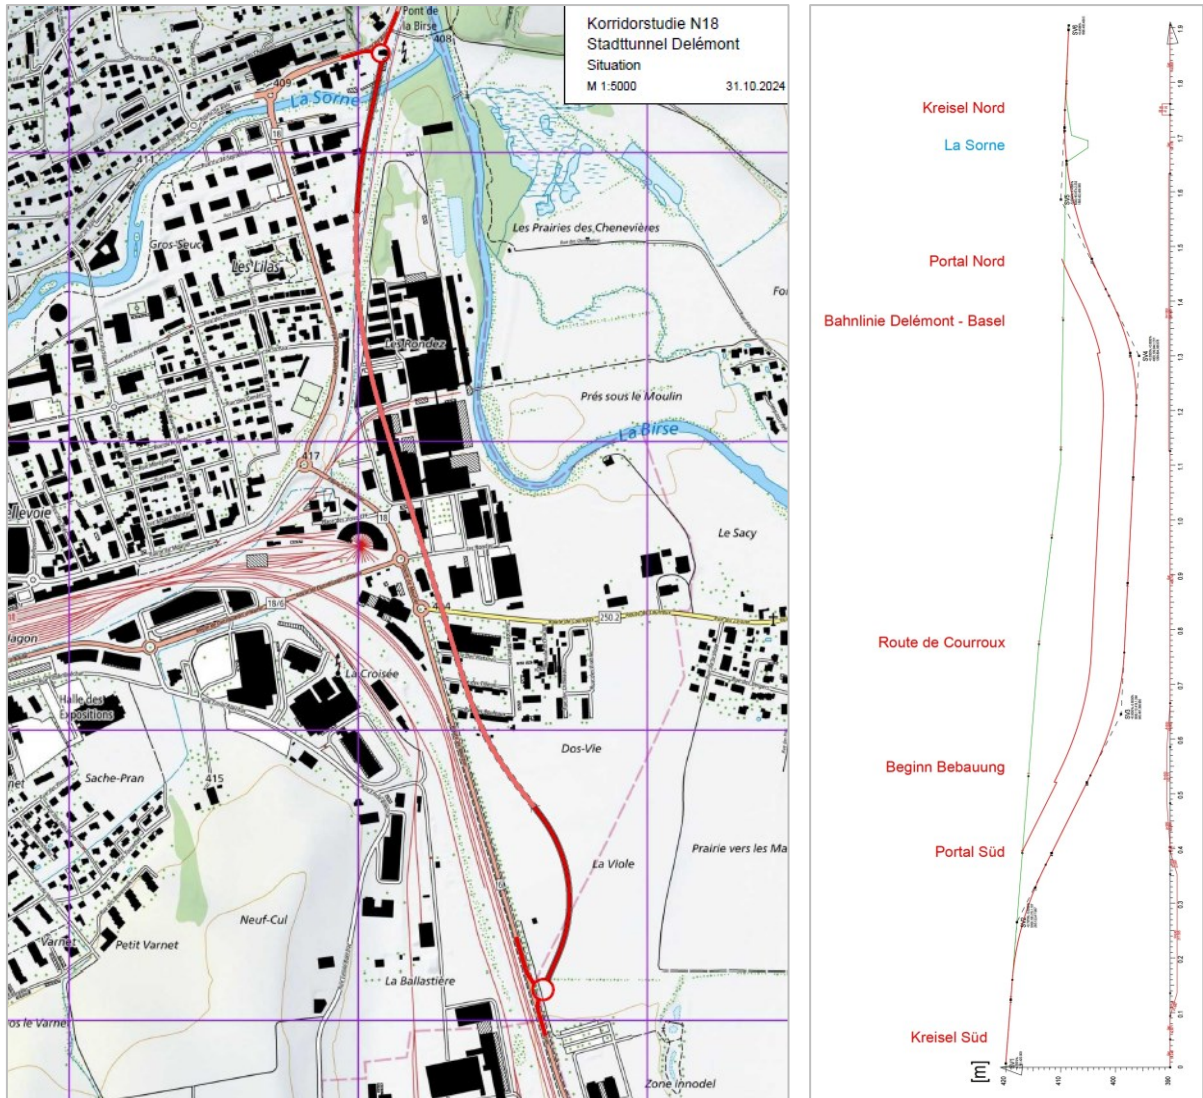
Mögliche Linienführung und Längenprofil Stadttunnel Delémont
